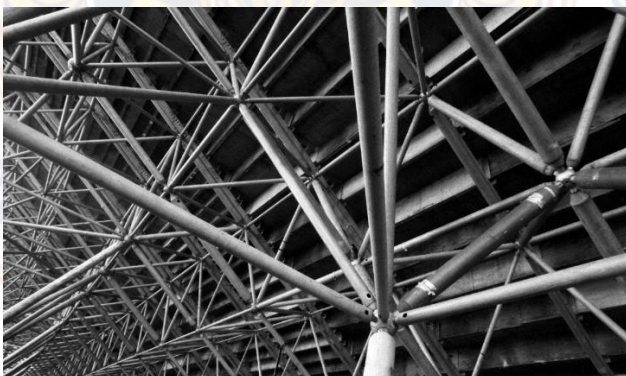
ระบบโครงสร้างผนังกระจก Structural (Glass Wall)
